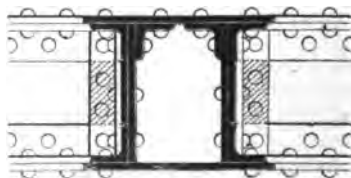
Poutres simples assemblées sur poutre tubulaire de hauteurs égales.
